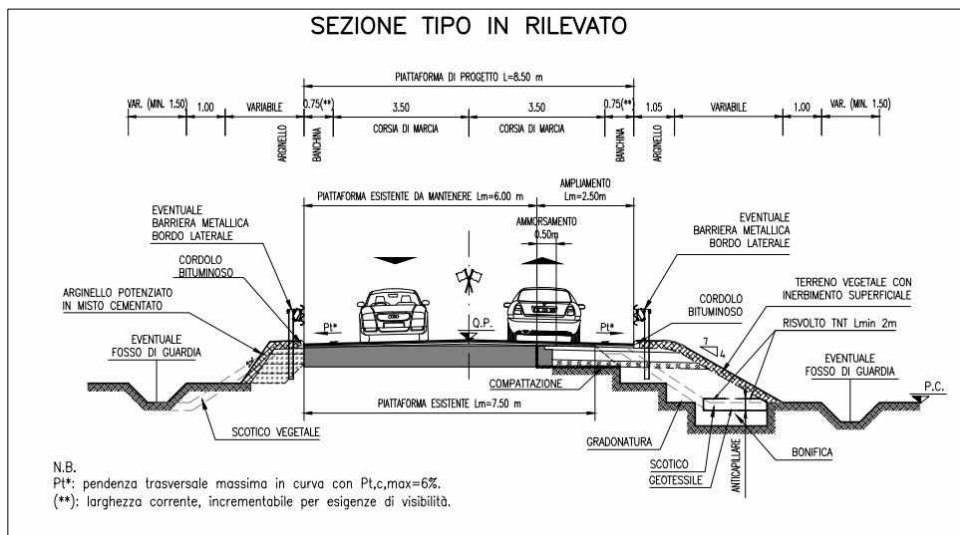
Sezione tipo in rilevato ampliamento Cavet
